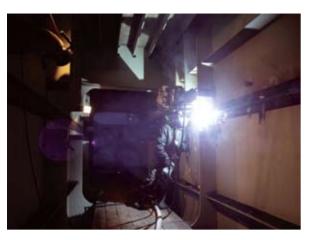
Автоматическая сварка порошковыми проволоками горизонтального и вертикального швов на мосту через Енисей
